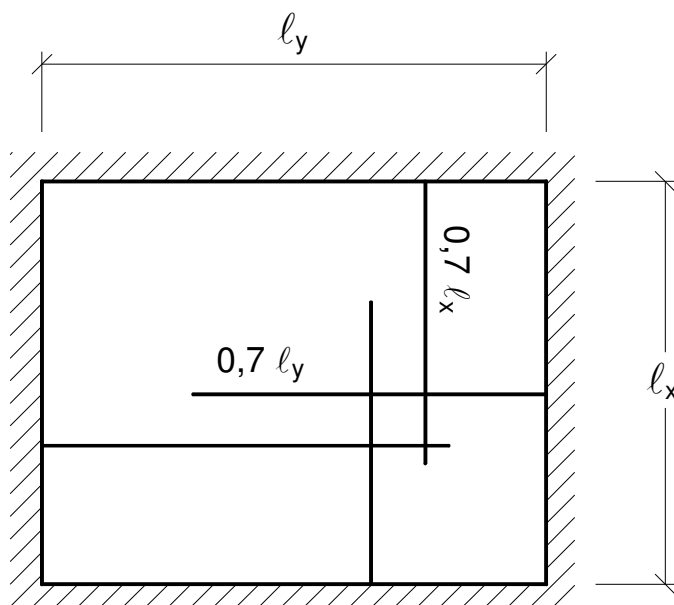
Comprimento mínimo das barras da armadura positiva entre duas bordas engastadas.
